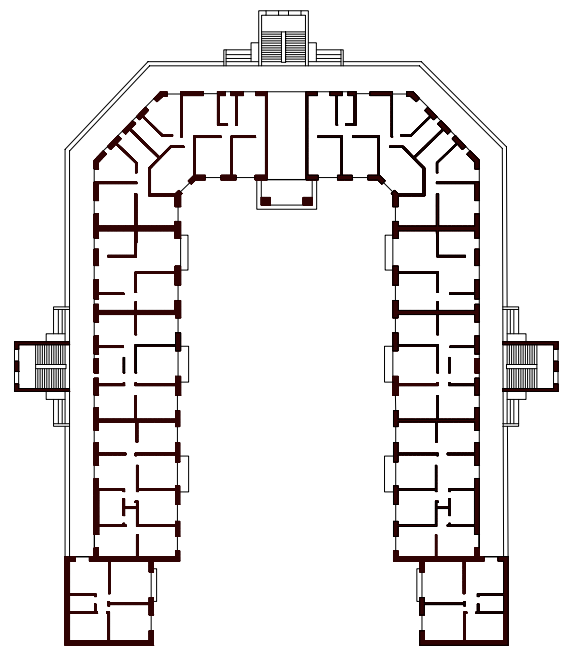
Planta baixa tipo Bloco Duque de Saldanha
